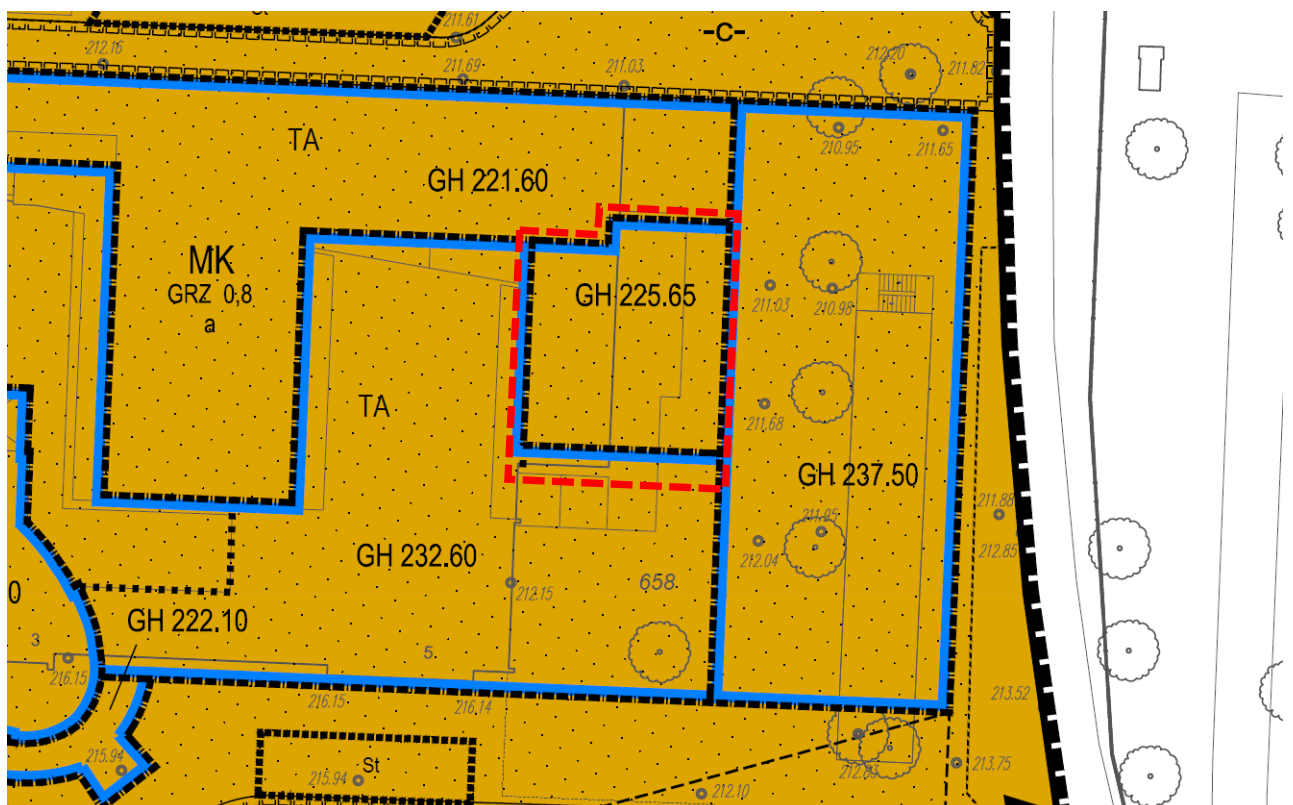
Ausschnitt Rechtsplan mit Darstellung des geänderten Bereiches
